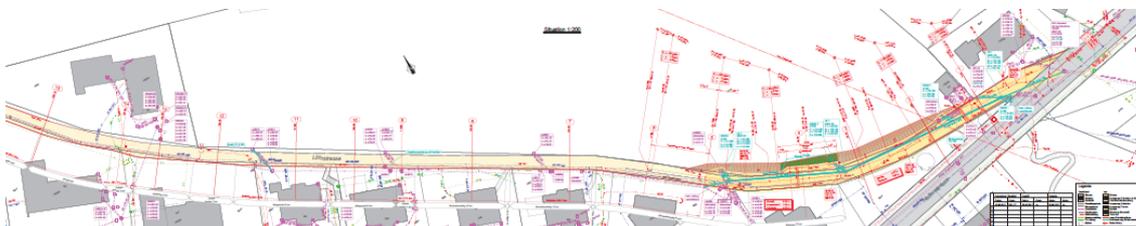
Situationsplan 1 des Bauprojekts, unterer Strassenabschnitt (Stand: Sept. 2012)
